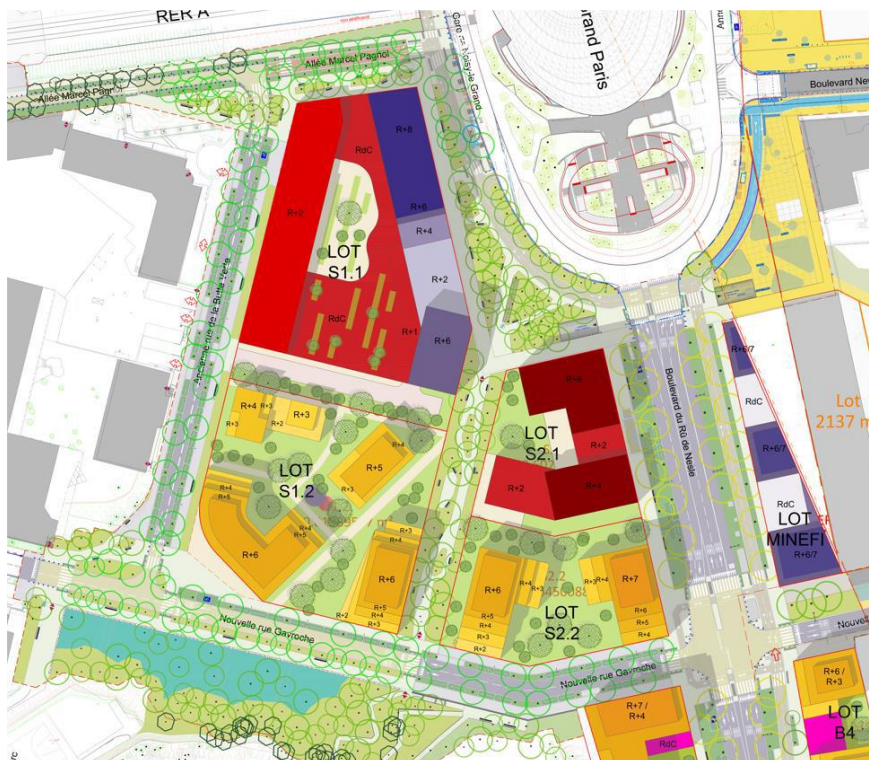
Plan masse du Pôle Gare Sud (source : dossier)
